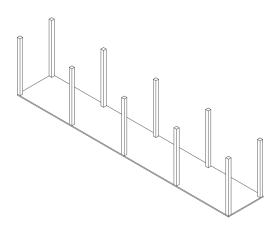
Axonometría estructural tipo 2_1 Fuente: Autores, 2024
